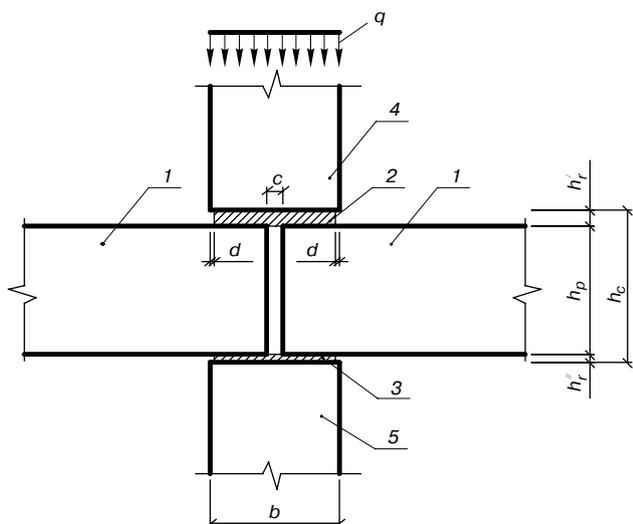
Платформенный стык между внутренними стеновыми панелями: 1 – опорные участки плит перекрытий; 2 и 3 – растворные швы; 4 – верхняя стеновая панель; 5 – нижняя стеновая панель; h'_r, h''_r – толщины соответственно верхнего и нижнего растворных швов; h_p – толщина плит перекрытия. Растворные швы не доходят до боковых граней стеновых панелей на $d=0,5$ см с каждой стороны. На практике это означает учет срывов растворных швов, пониженной прочности части шва на границе с воздухом
